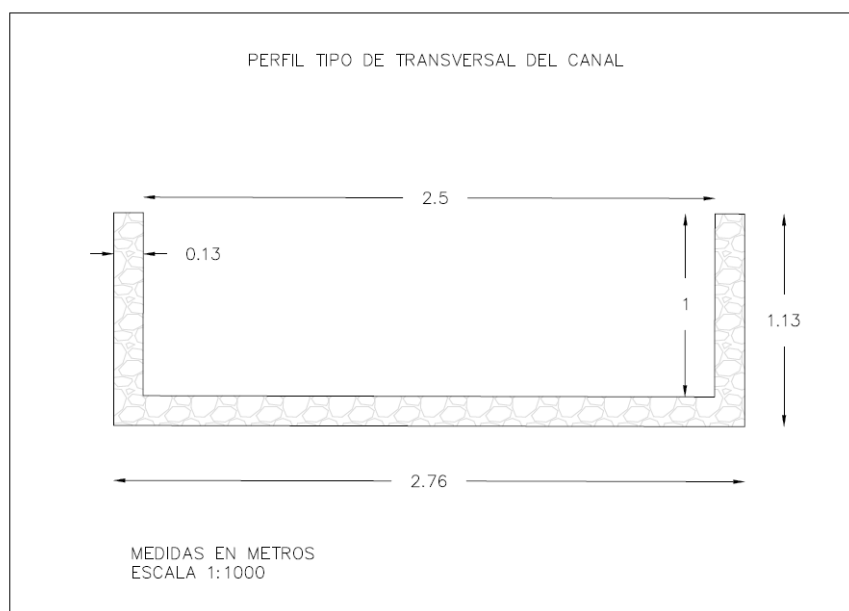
Ancho de solera, alturas de muro y espesor de losa. Fuente elaboración propia.
